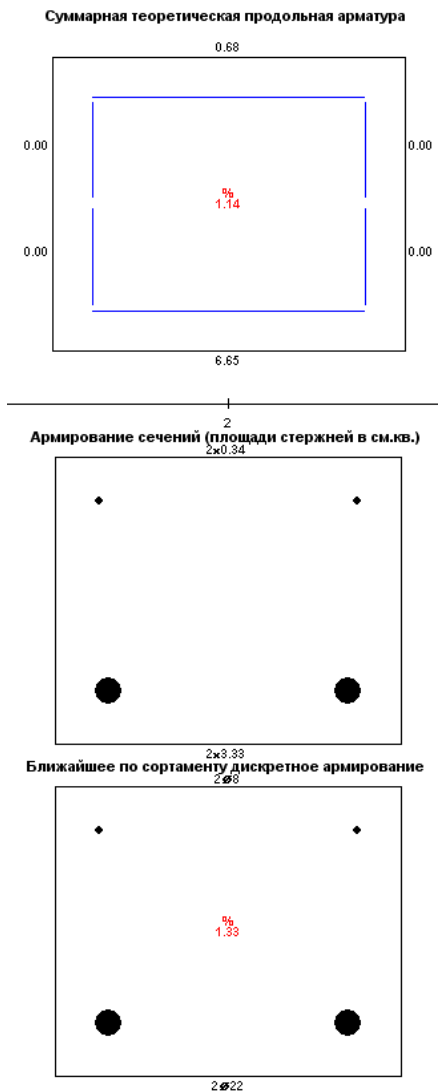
Продольное армирование ригеля в середине пролета
